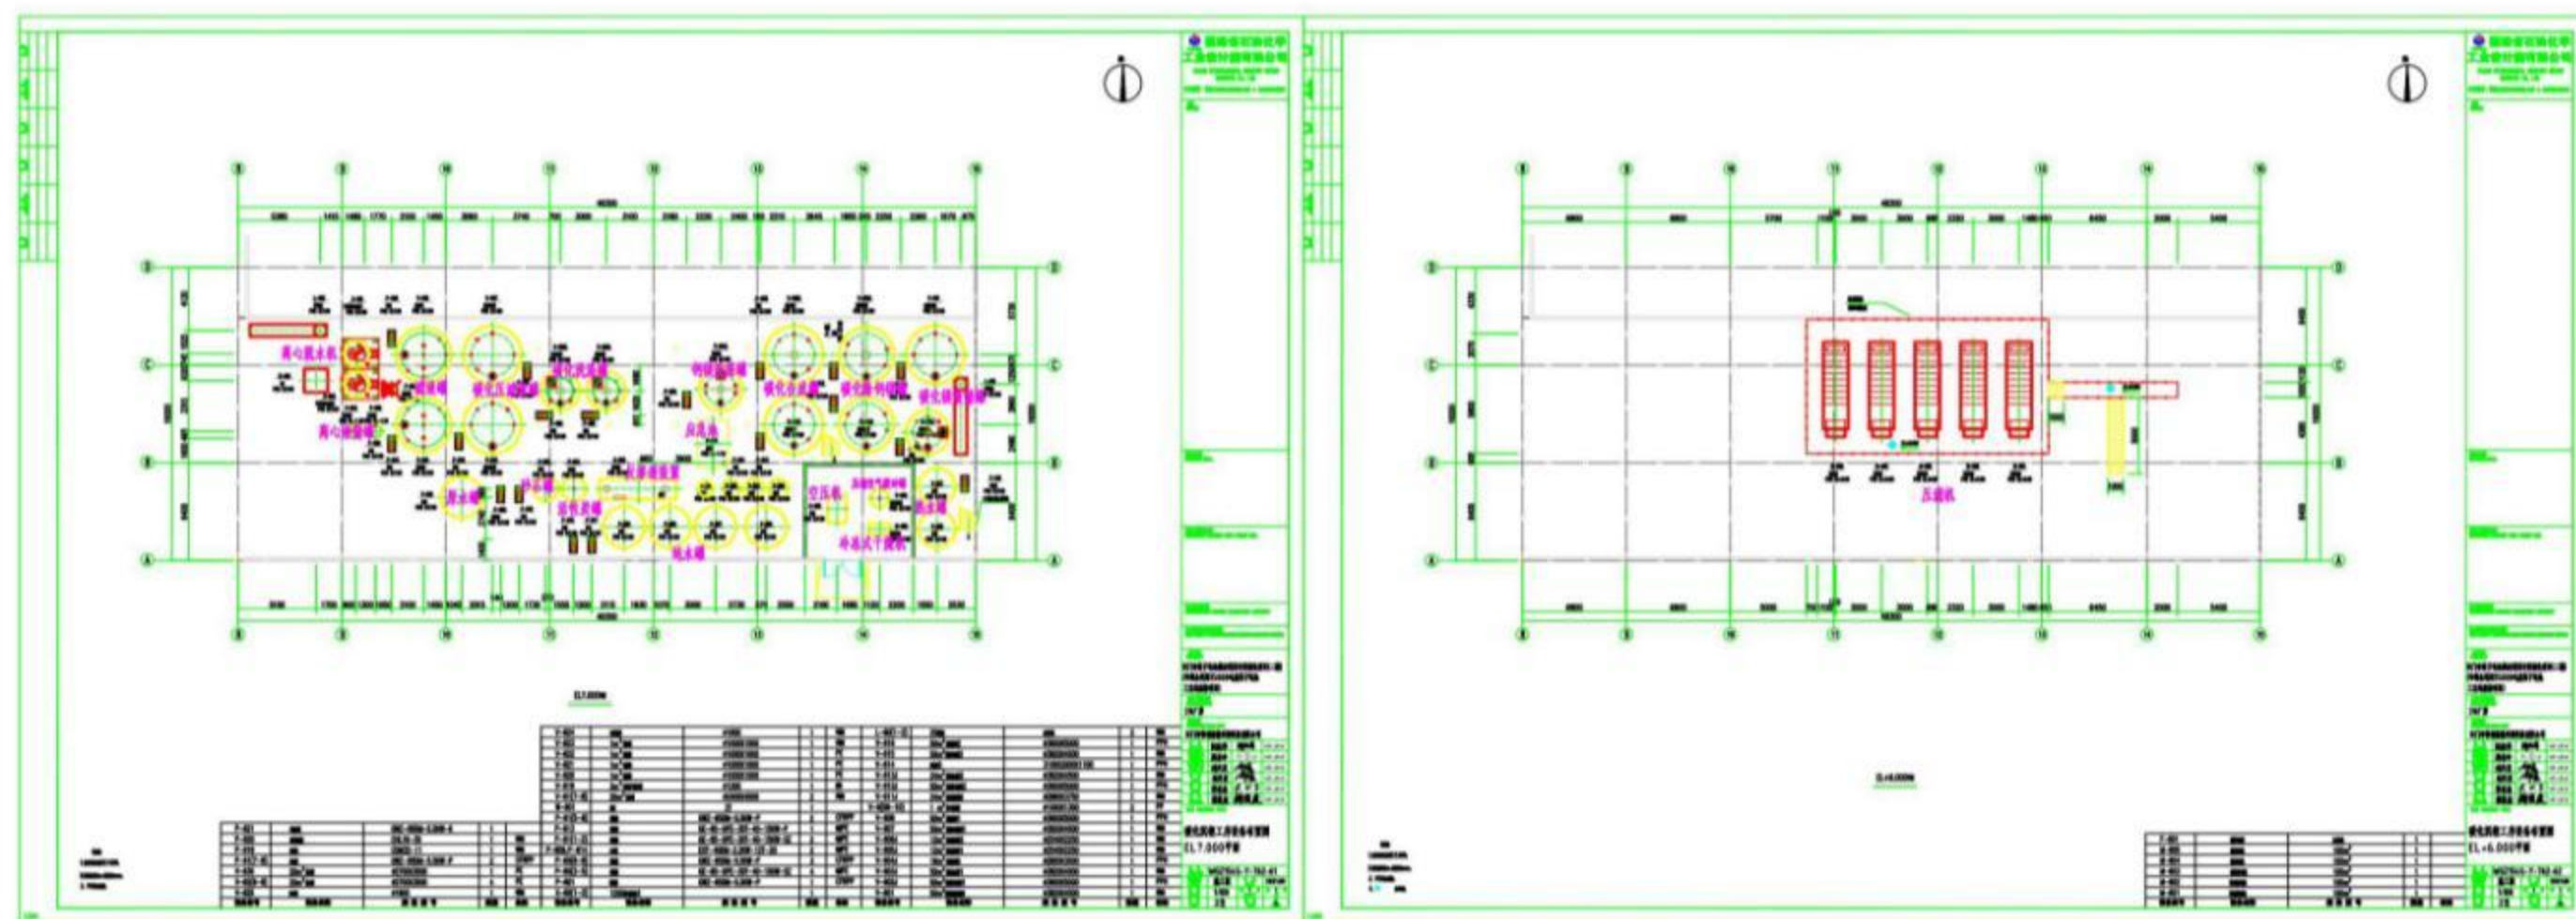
2#厂房碳化沉锂区域平面布置图
